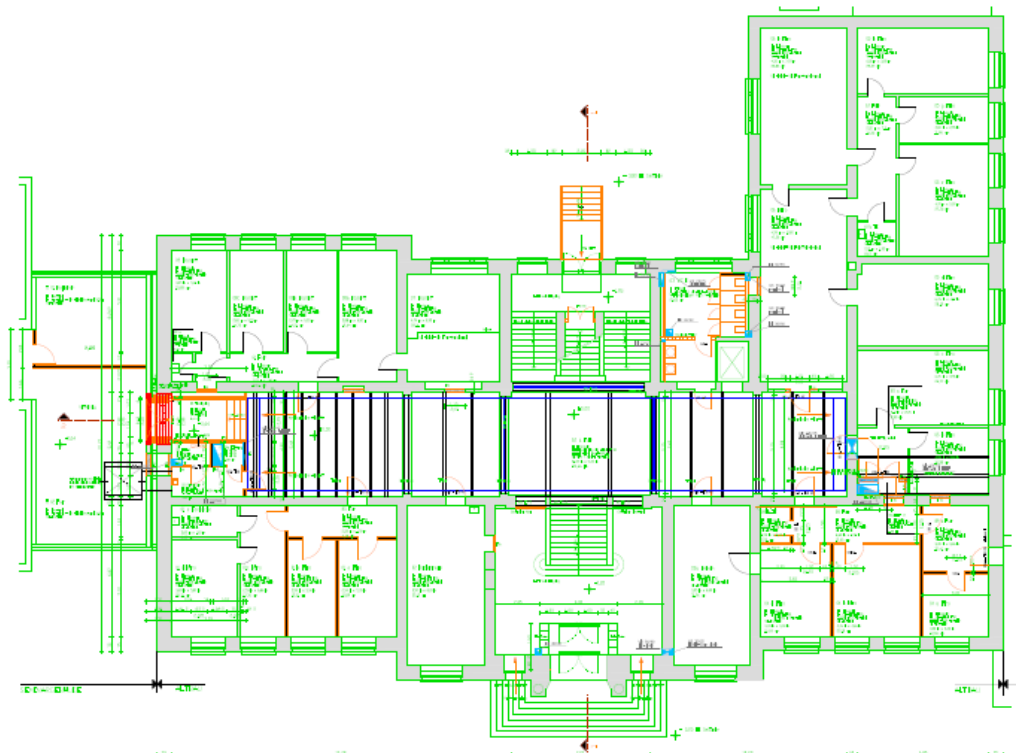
Grundrissplan EG, Gebäude HD
